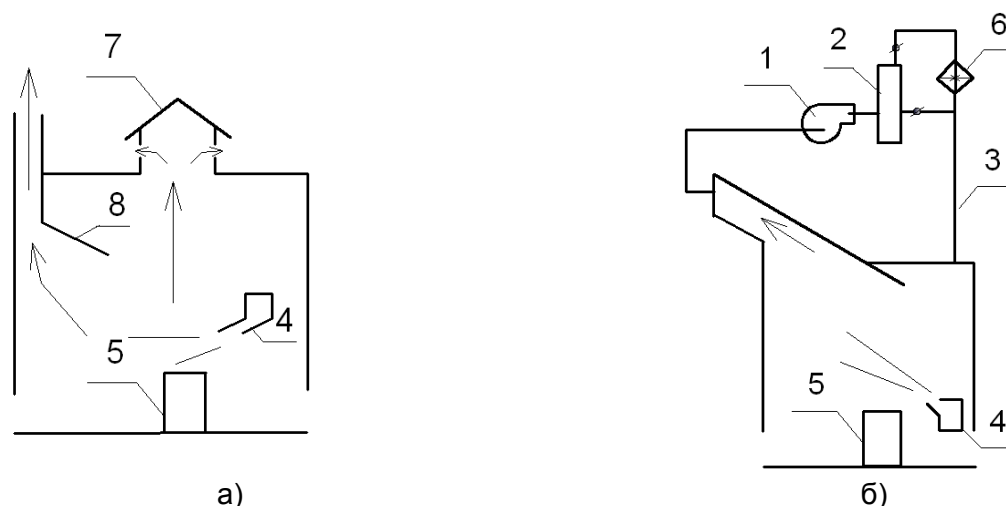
Схемы вентиляции цеха: а) естественная с использованием местного отсоса с передувкой и фонаря; б) со скатной крышей и теплоутилизатором: 1 – вентилятор; 2 – пылегазоочистная установка; 3 – рециркуляционный воздухопровод; 4 – приточный насадок; 5 – источник тепловыделений; 6 – рекуператор теплоты; 7 – аэрационный фонарь; 8 – местный отсос
